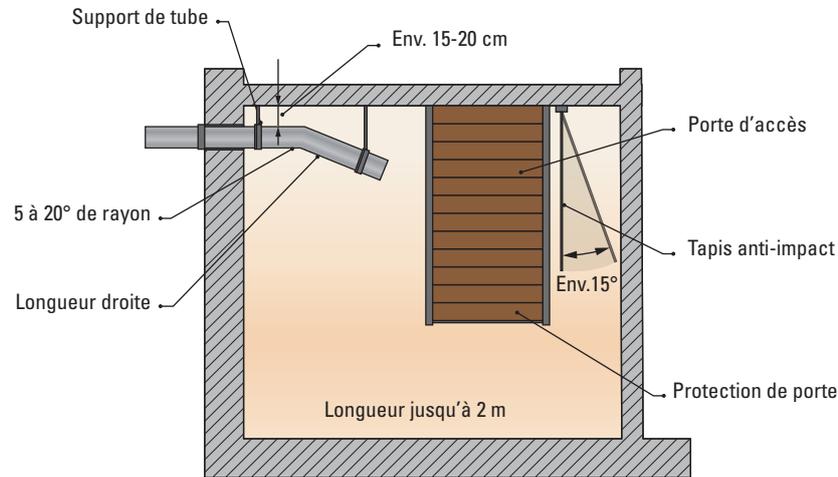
Coupe longitudinale d'un silo de longueur inférieure à 2 m.
